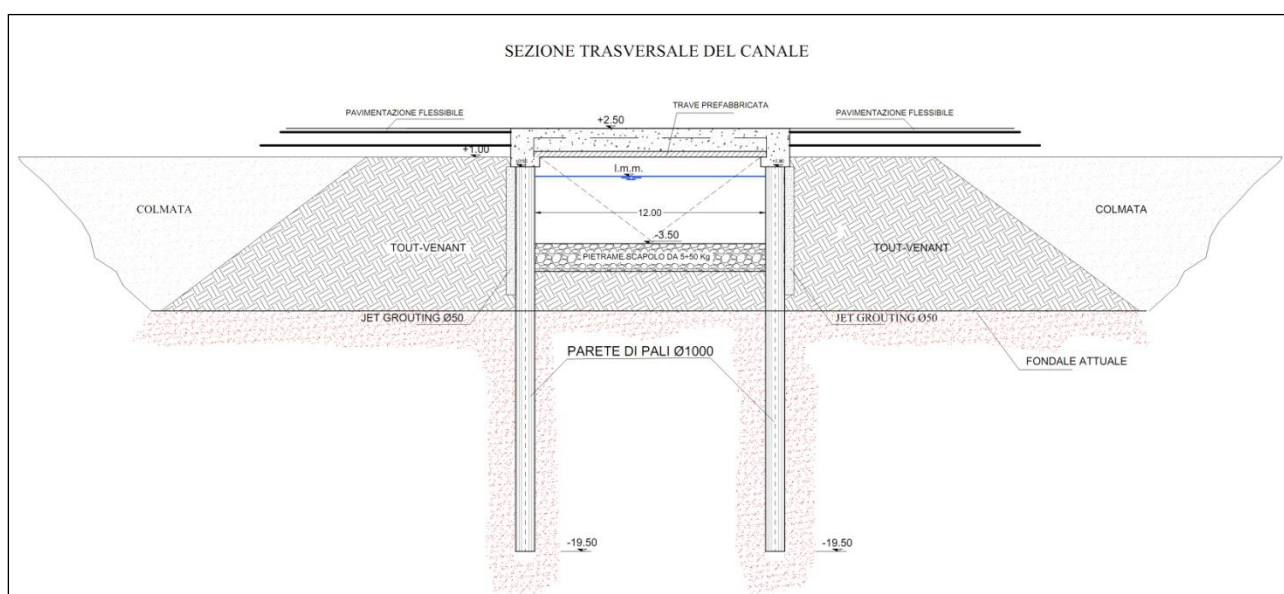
Sezione Trasversale del canale tombato come da progetto esecutivo
